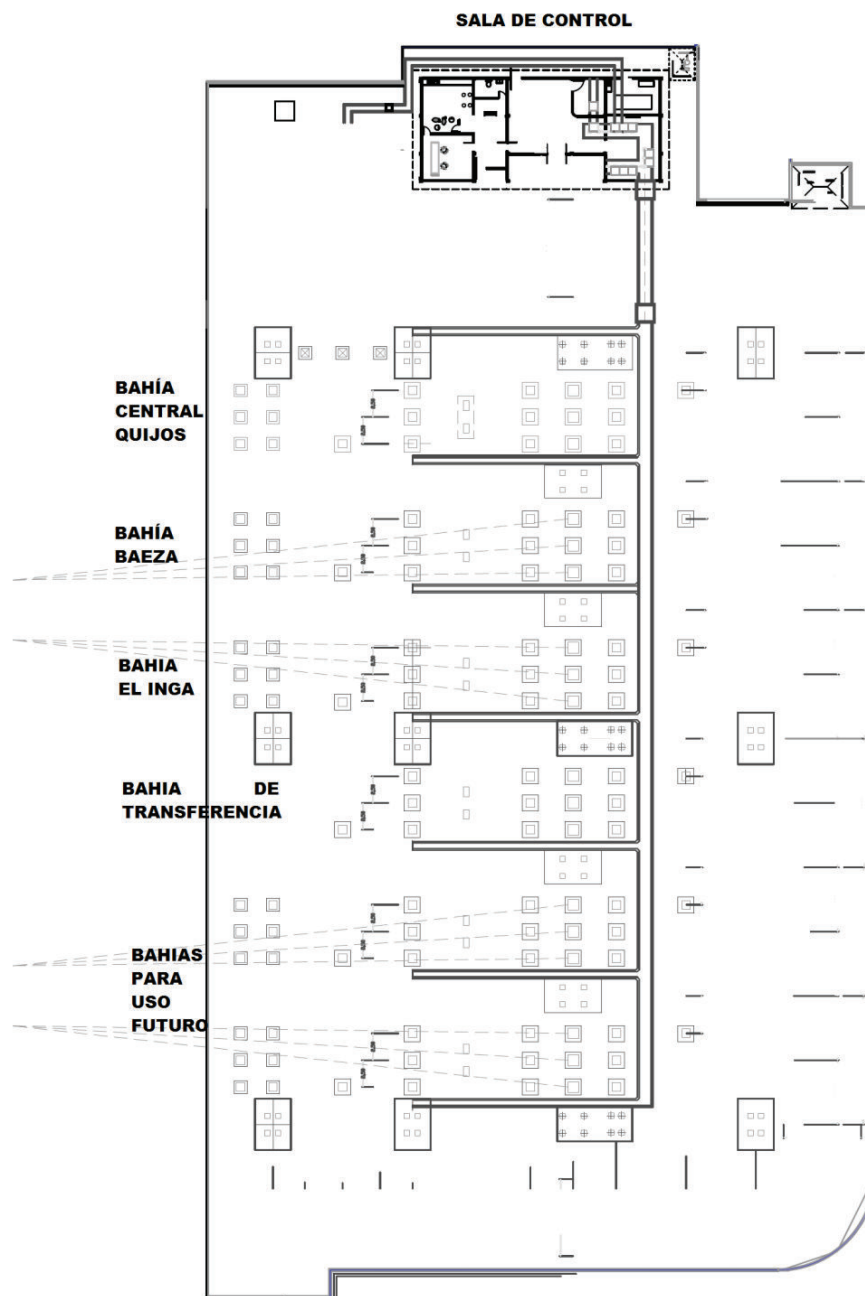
Diagrama de la Subestación de Seccionamiento [46]
